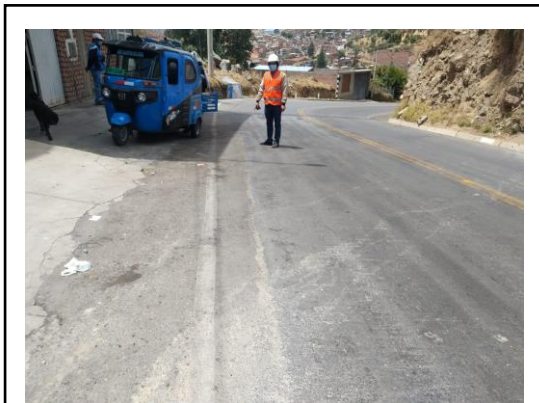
Fallas tipo "B" "Desintegración de bordes del pavimento"
